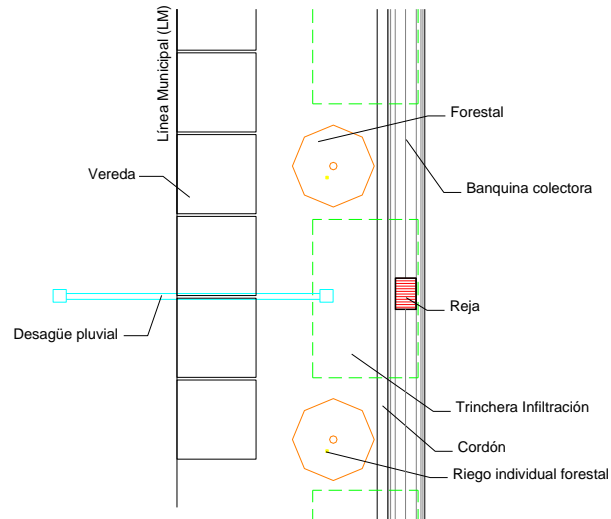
Detalle planimétrico con ubicación de trincheras de infiltración entre forestales
